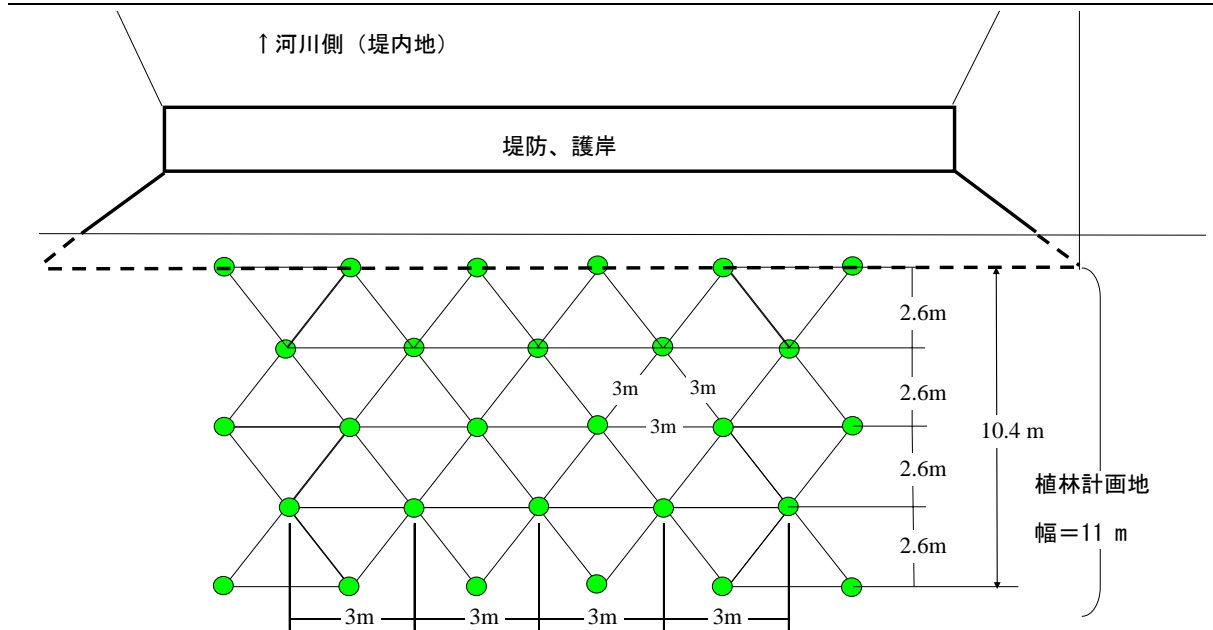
河川構造物沿いの植林計画標準配置図 (タイプ A)
